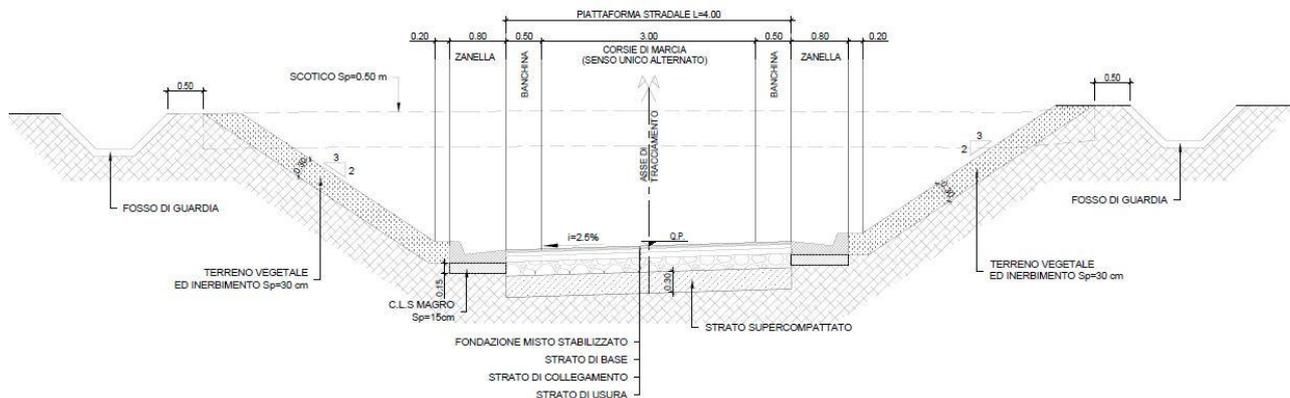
Dest. Particolare 4.0 m - sezione tipo in trincea
